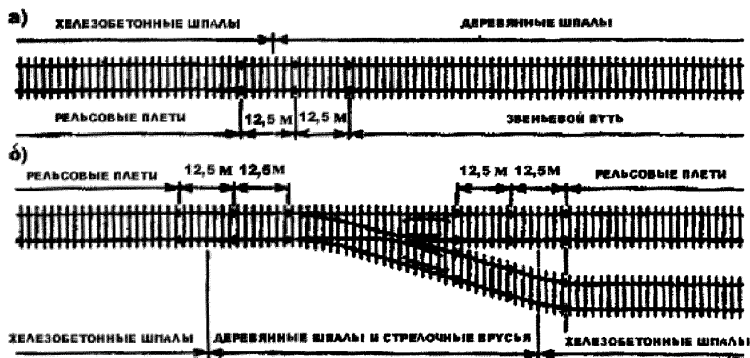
Схемы примыкания бесстыкового пути на железобетонных шпалах:
